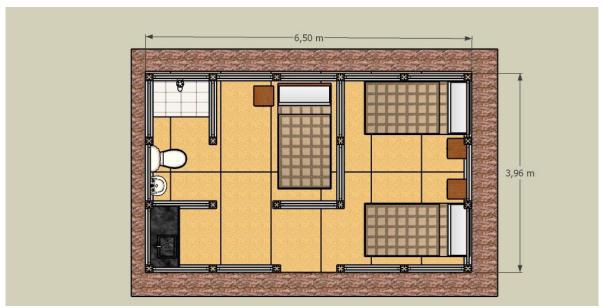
Planimetría vivienda de emergencia con las uniones planteadas.
